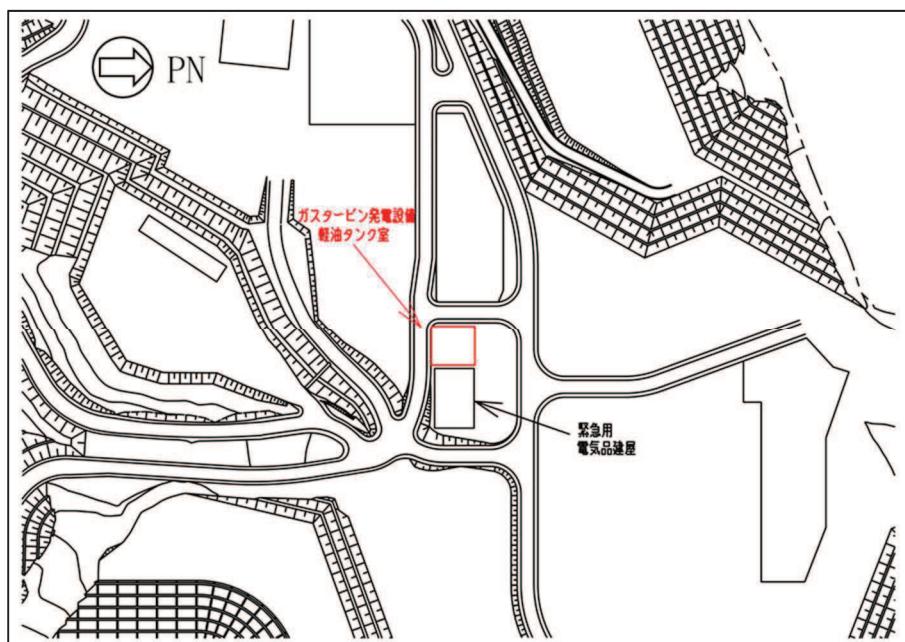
ガスタービン発電設備軽油タンク室配置図
